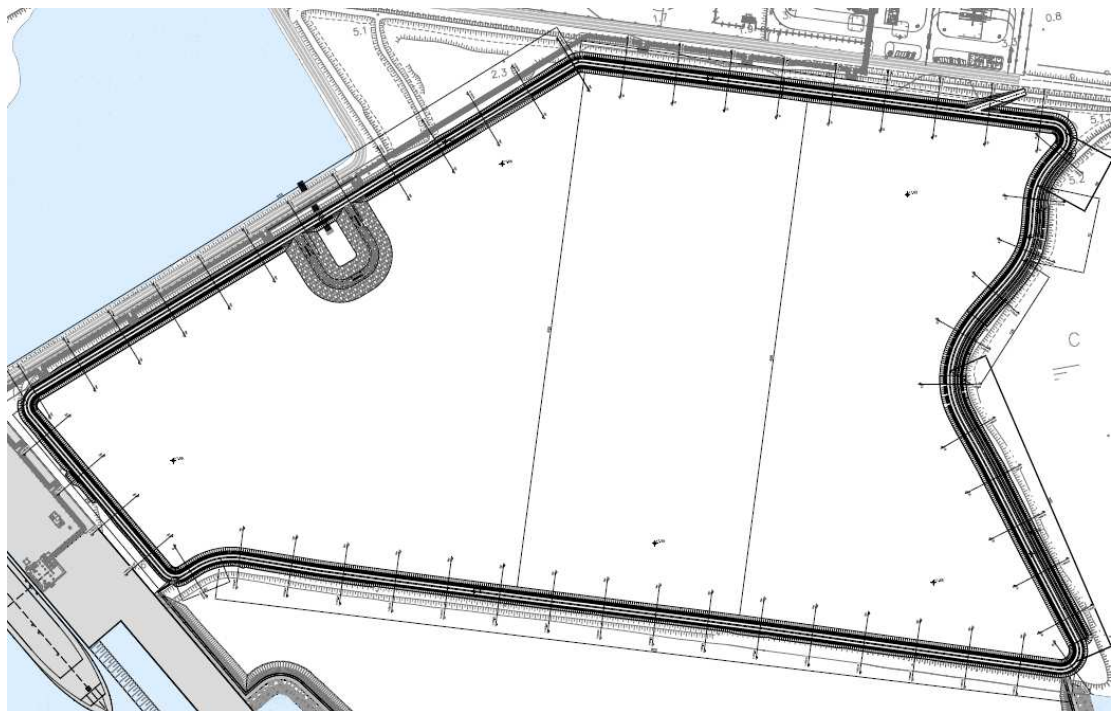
Area 10 - Planimetria colmata Area Lisert
